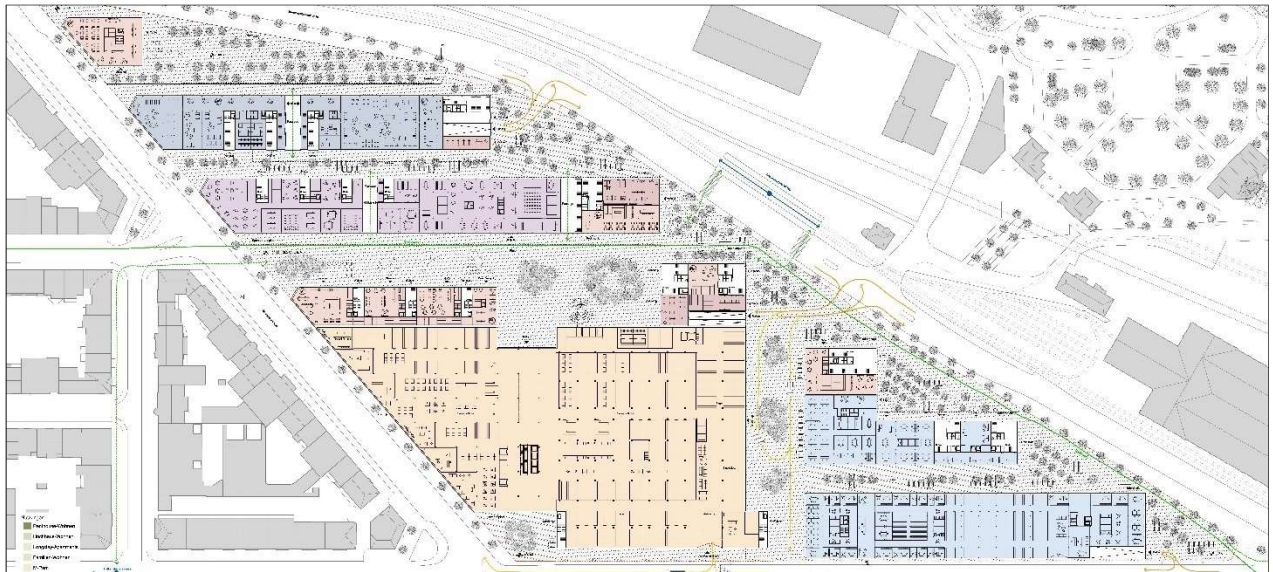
Vorschlag Christ & Gantenbein. Situationsplan (Plan nicht genordet, kein Massstab). Quelle: Christ & Gantenbein
